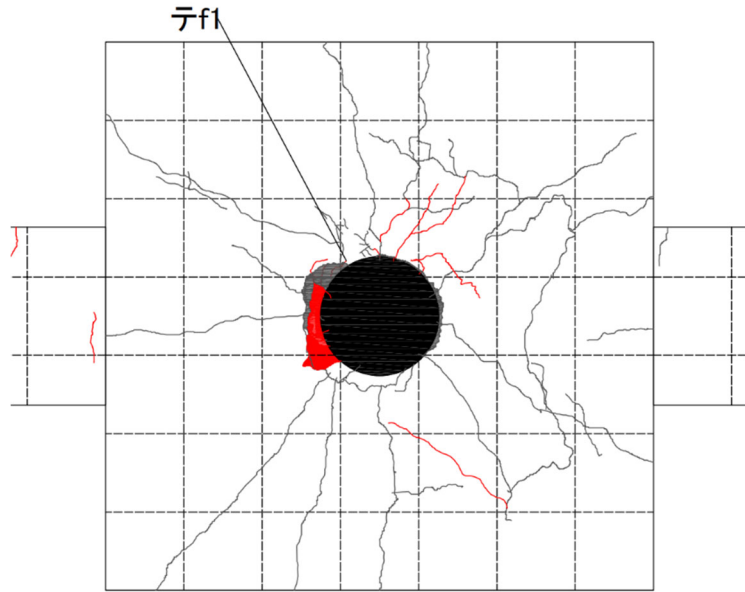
パイルキャップ底面ひび割れ幅測定位置 (試験体 DR-5 -7.0 サイクル)
